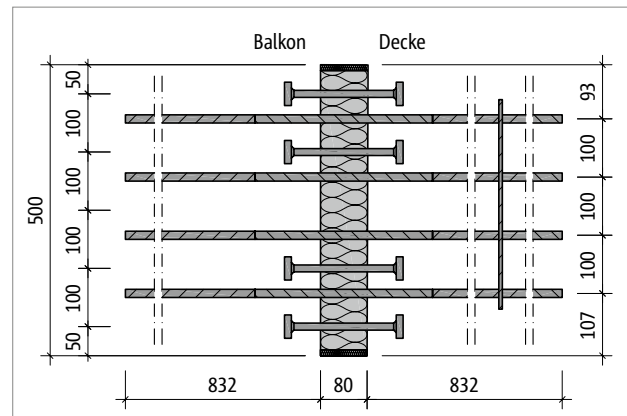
Schöck Isokorb® T Typ QP-V10: Produktgrundriss
